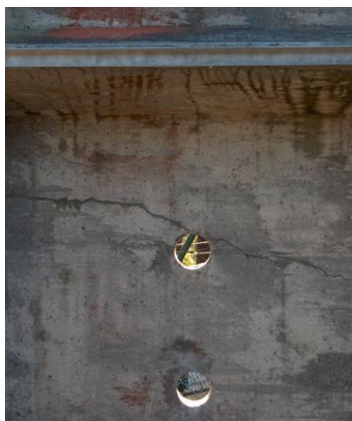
Fissuração e presença de manchas na zona interior do perfil
